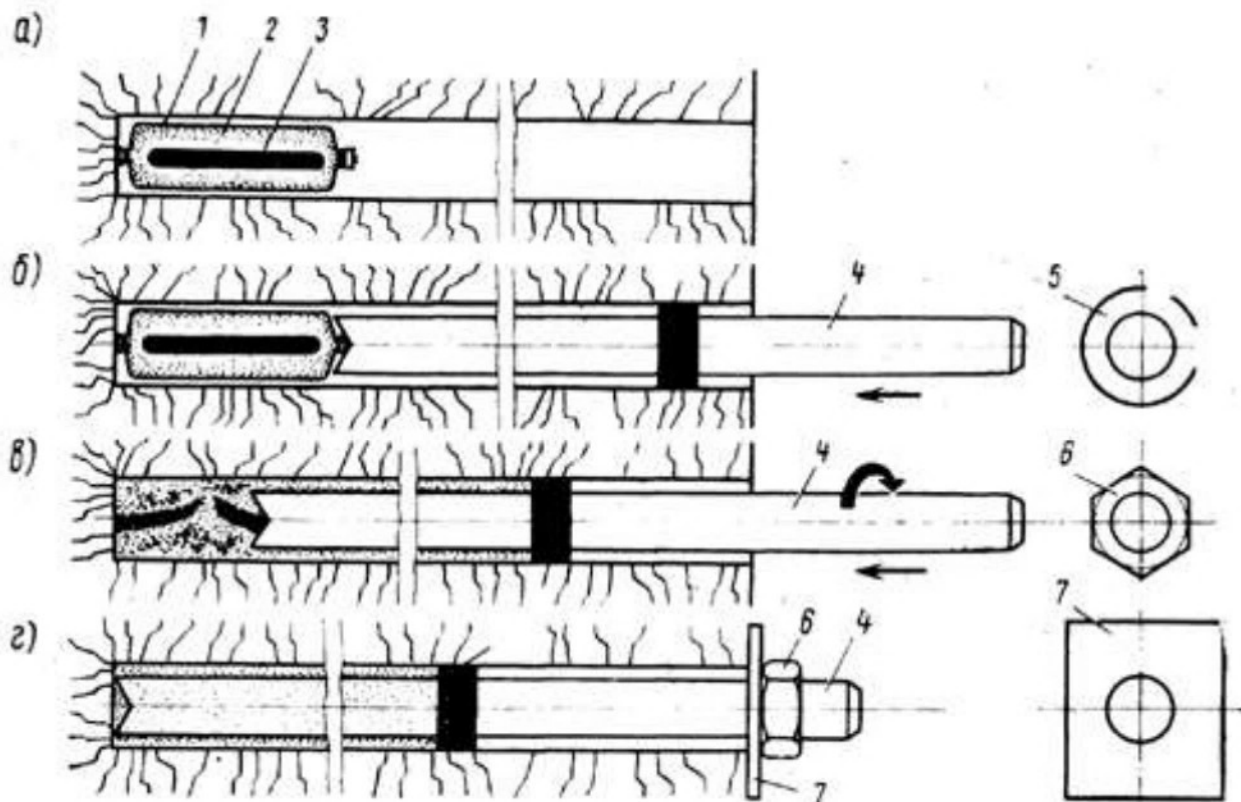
Схема установки сталеполімерного анкера:
